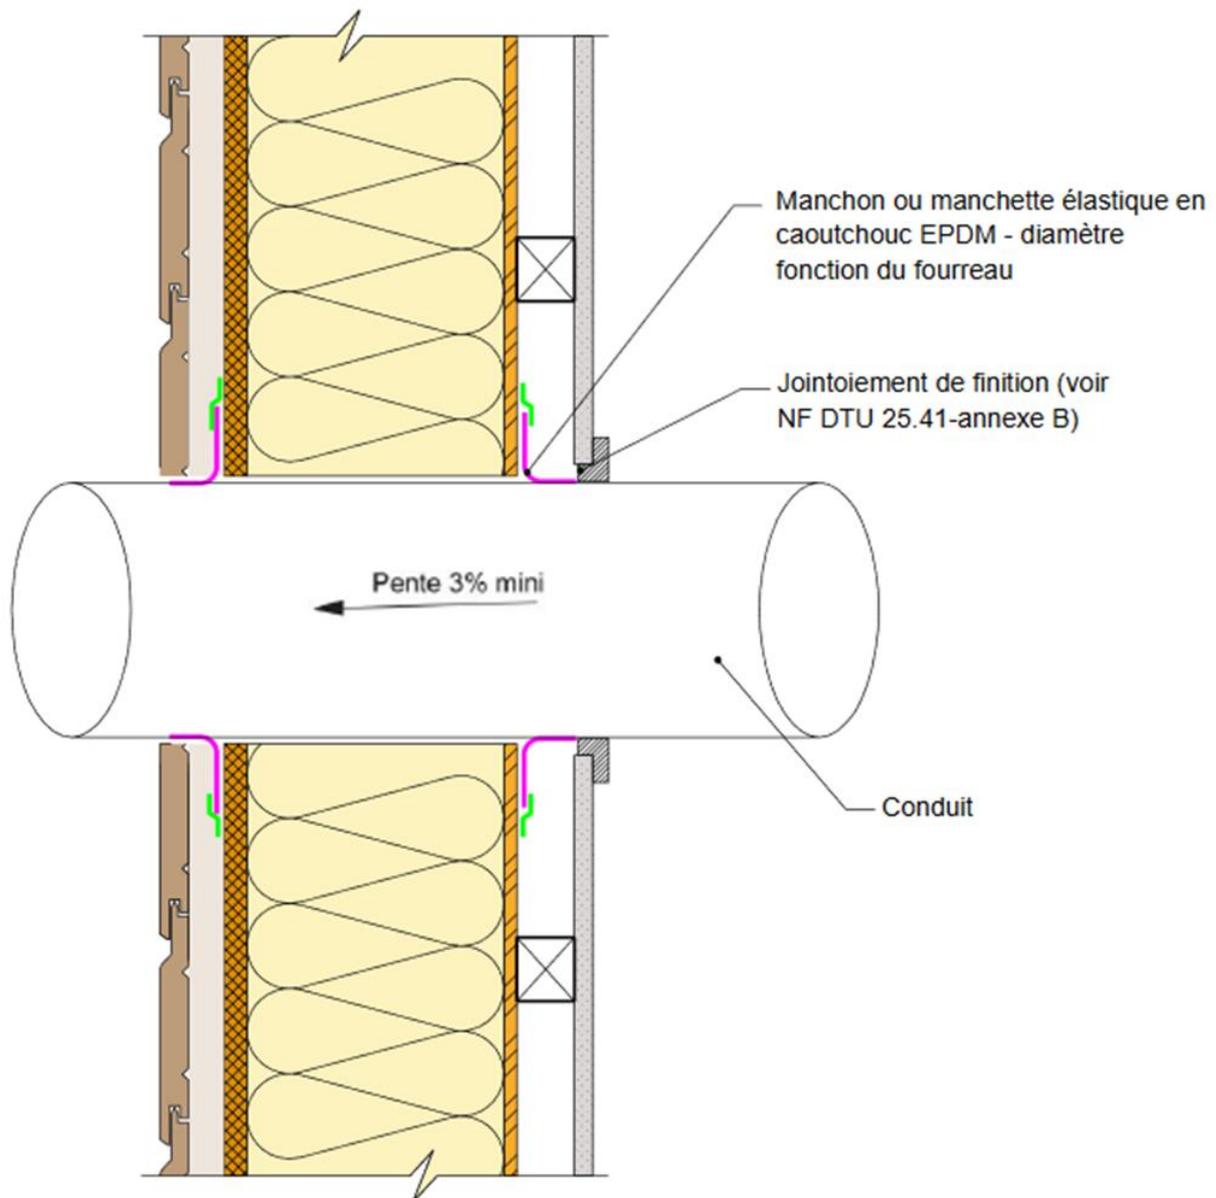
Exemple de traitement de la traversée d'une paroi sans membrane souple (pare-pluie et pare-vapeur) (coupe verticale)
